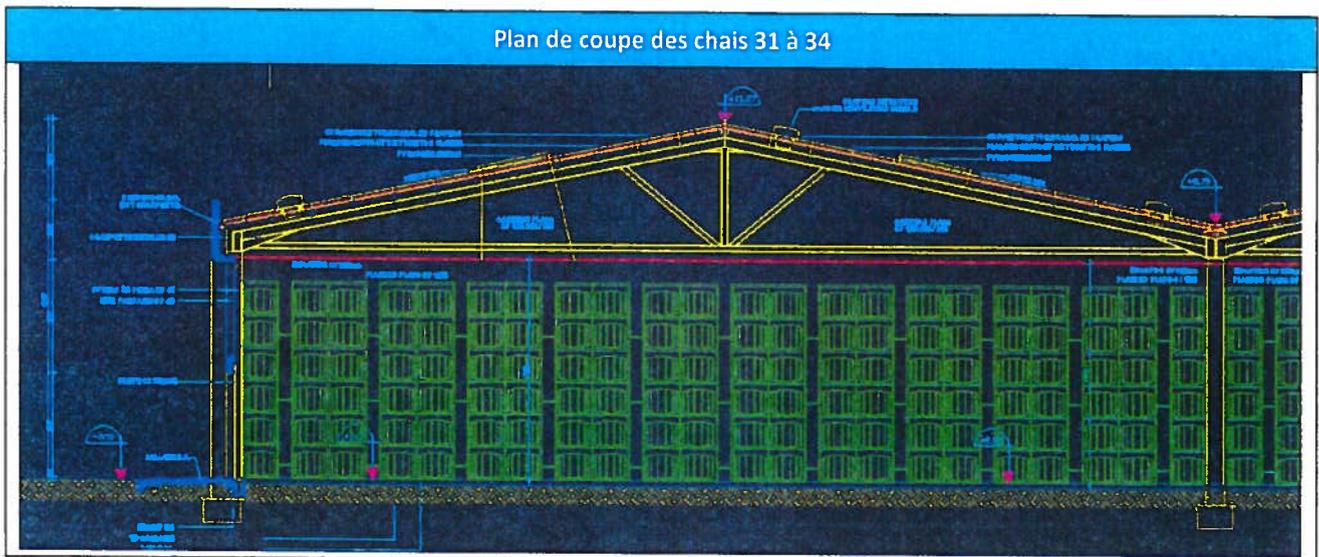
Extrait du plan de coupe des chais 31 à 34
